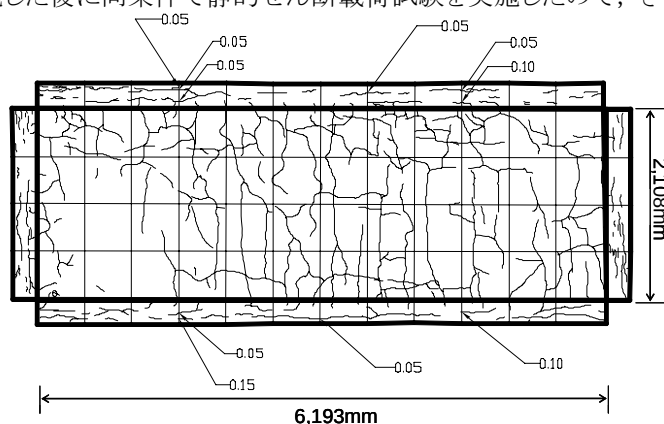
切り出した RC スラブのひび割れ状況(展開図)
